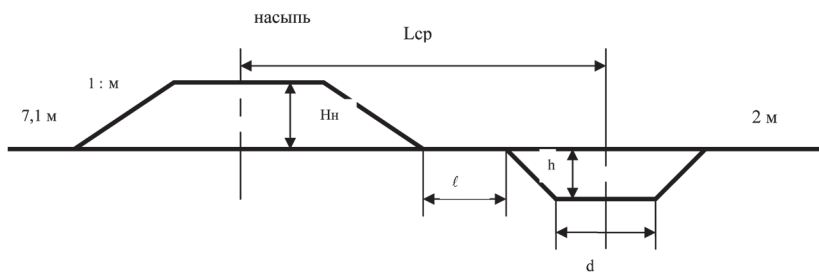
Схема для поперечной дальности грунта из резерва в насыпь при высоте насыпи до 6 м
